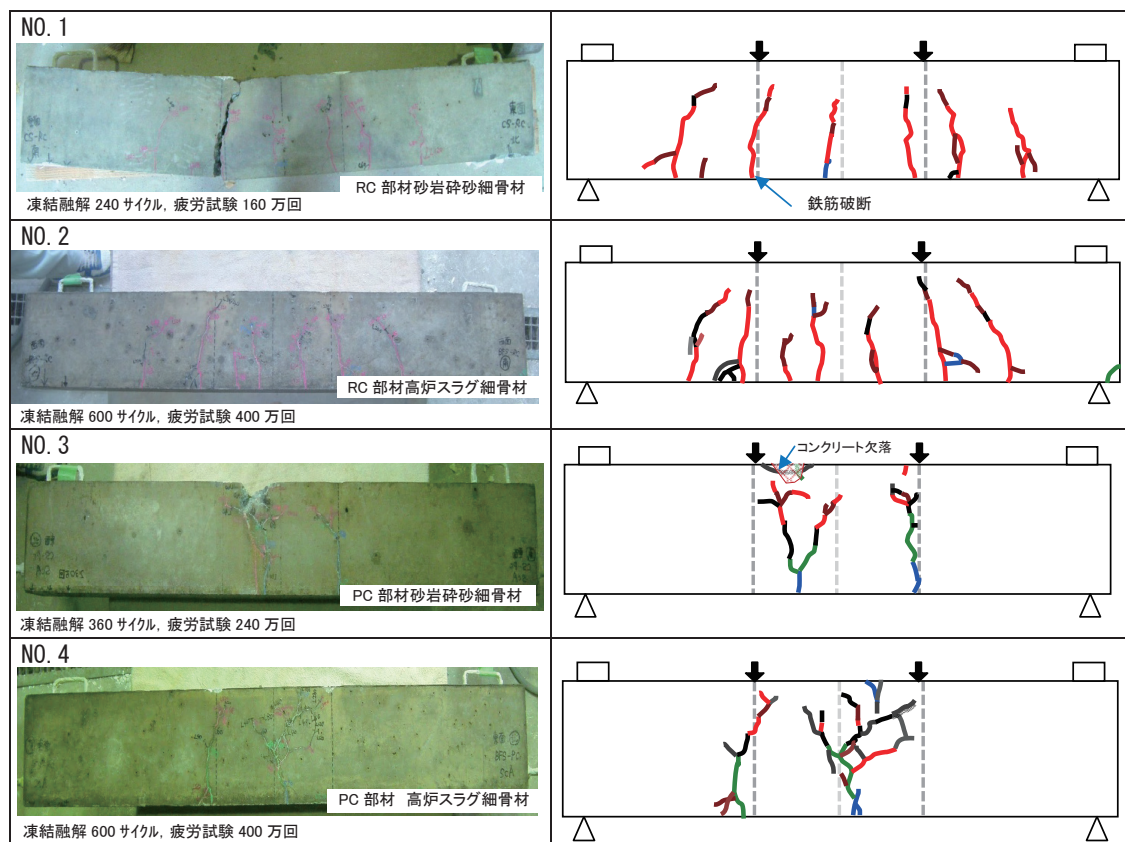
複合劣化試験の終了時の状況とひび割れ図
